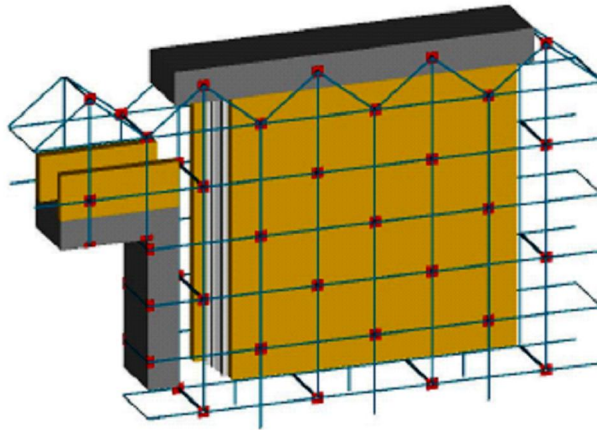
Arrangement du système CAM sur un mur en maçonnerie
